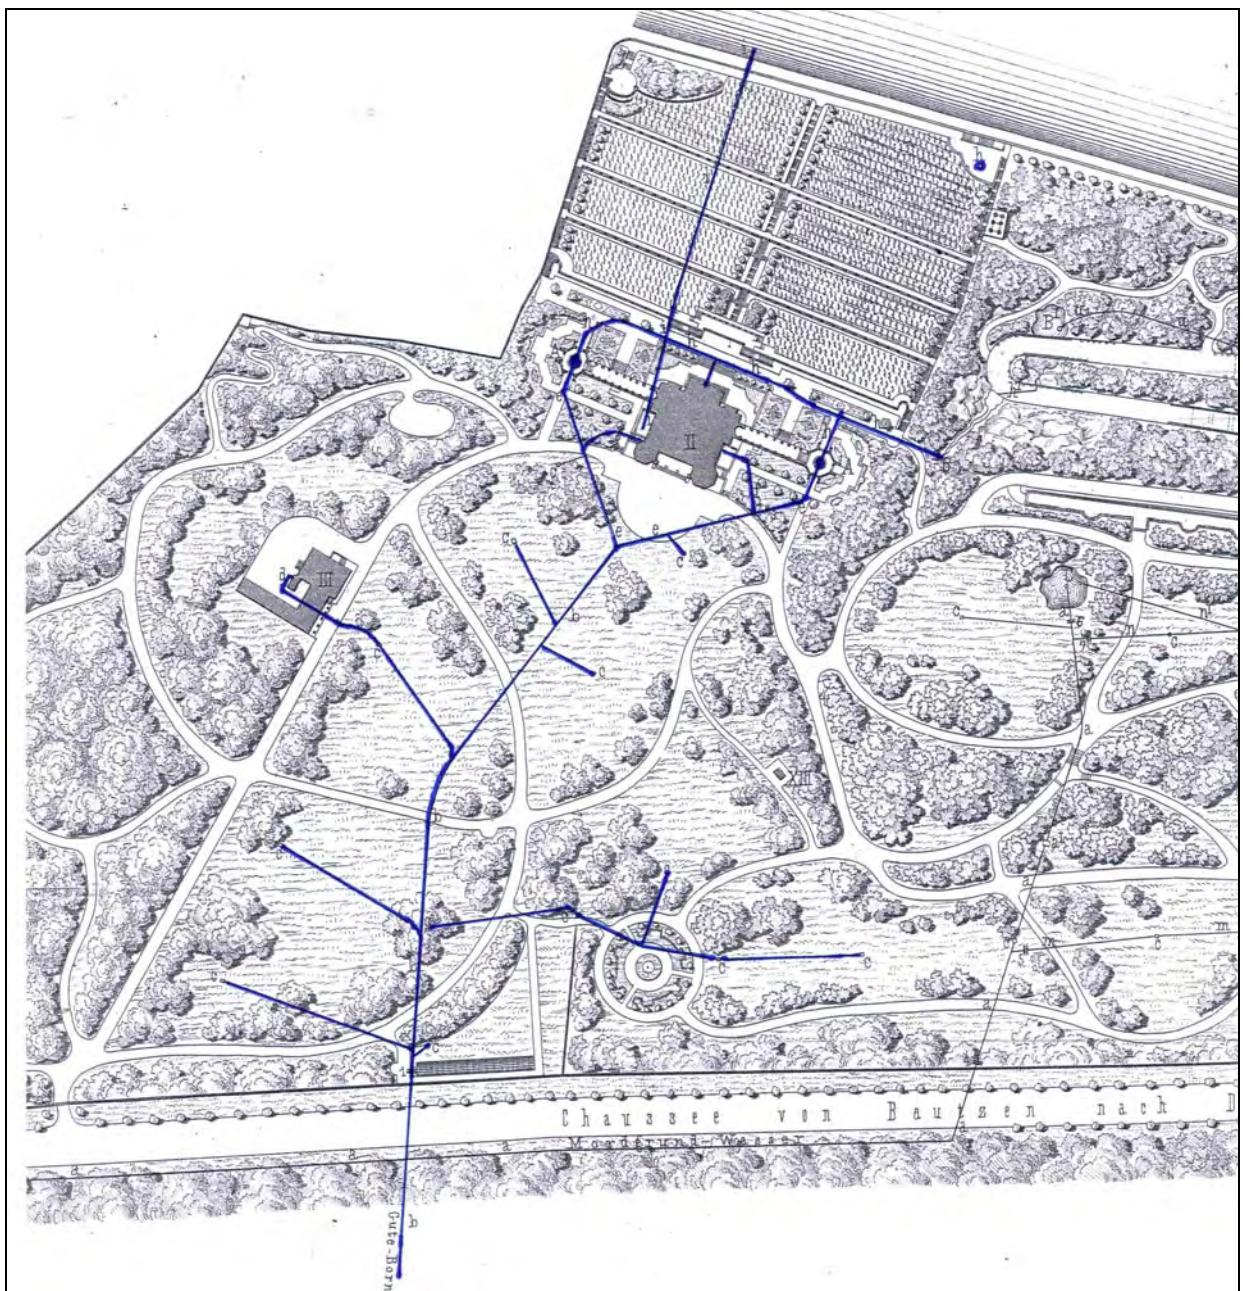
Lageplan der Wasserleitungen im Park der Villa Stockhausen, 1855
